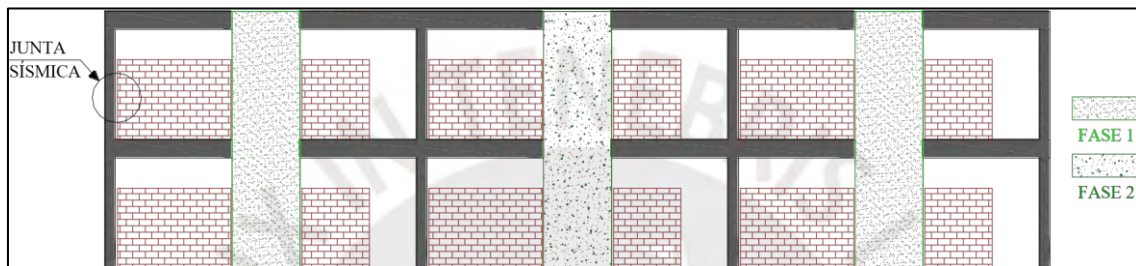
Vista en elevación de un pórtico en la dirección longitudinal (Fuente: Loa, 2017)
